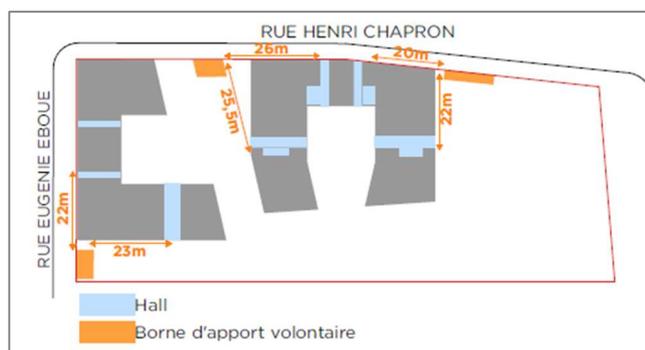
Emplacement des bornes d'apport volontaires - Source : PPX architectes - 18/12/2023
